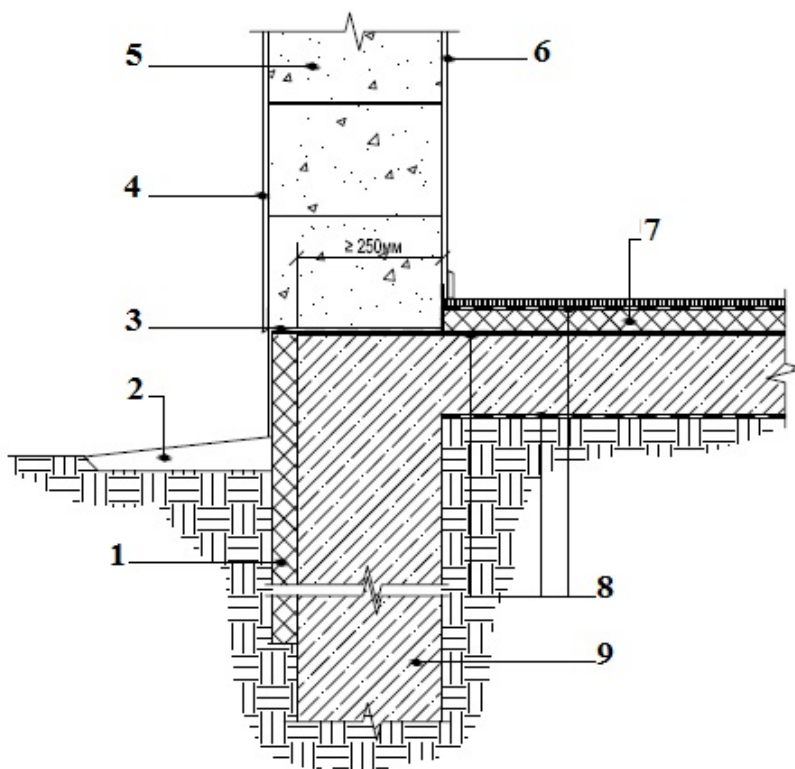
Узел опирания наружной стены на железобетонное основание:
